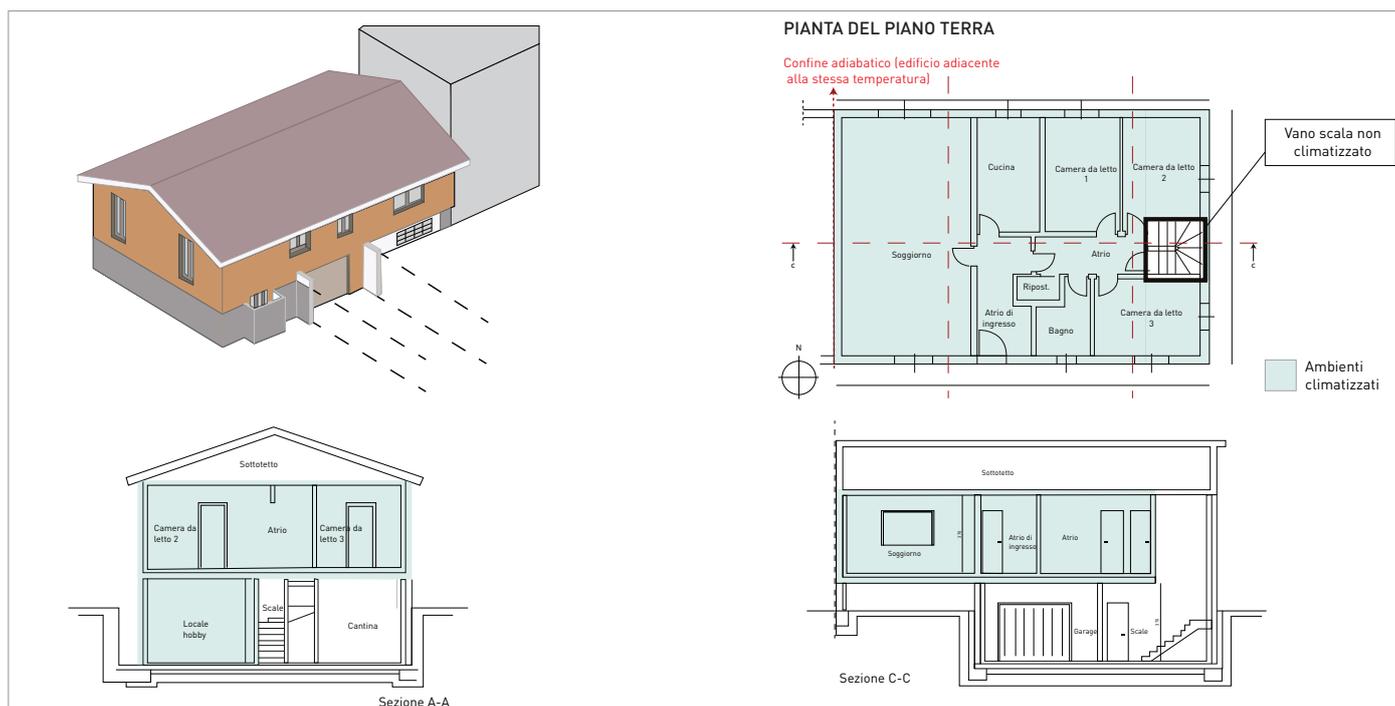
Assonometria, planimetria e prospetti dell'edificio oggetto dell'esempio.
